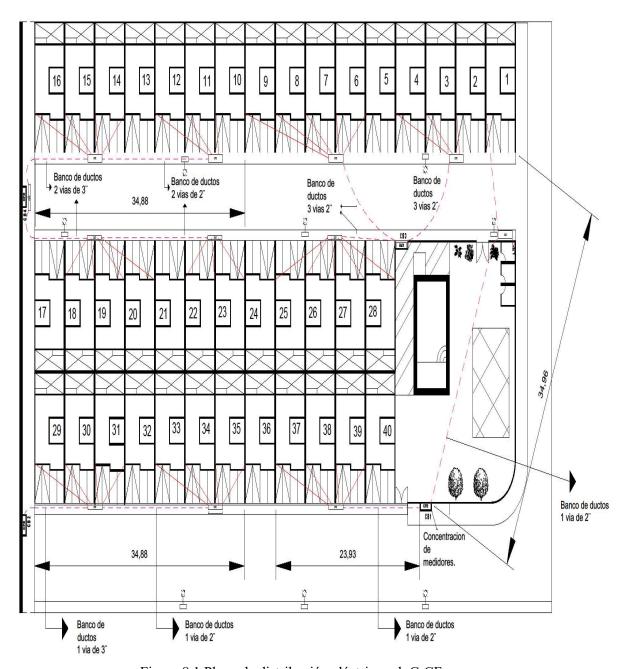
Plano de distribución eléctrica sub C-CF.
